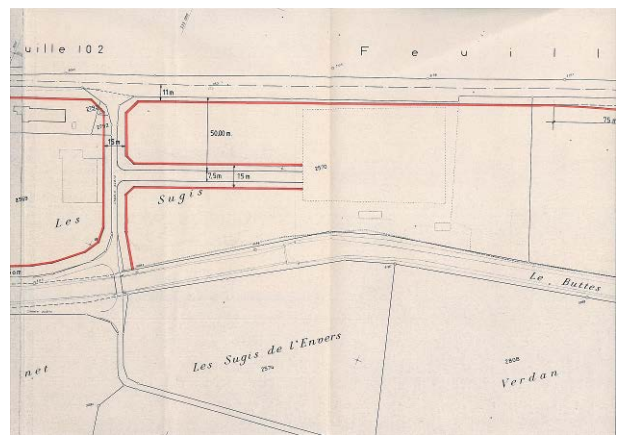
Extrait du plan d'alignement "zone industrielle" en vigueur (partie Est)
